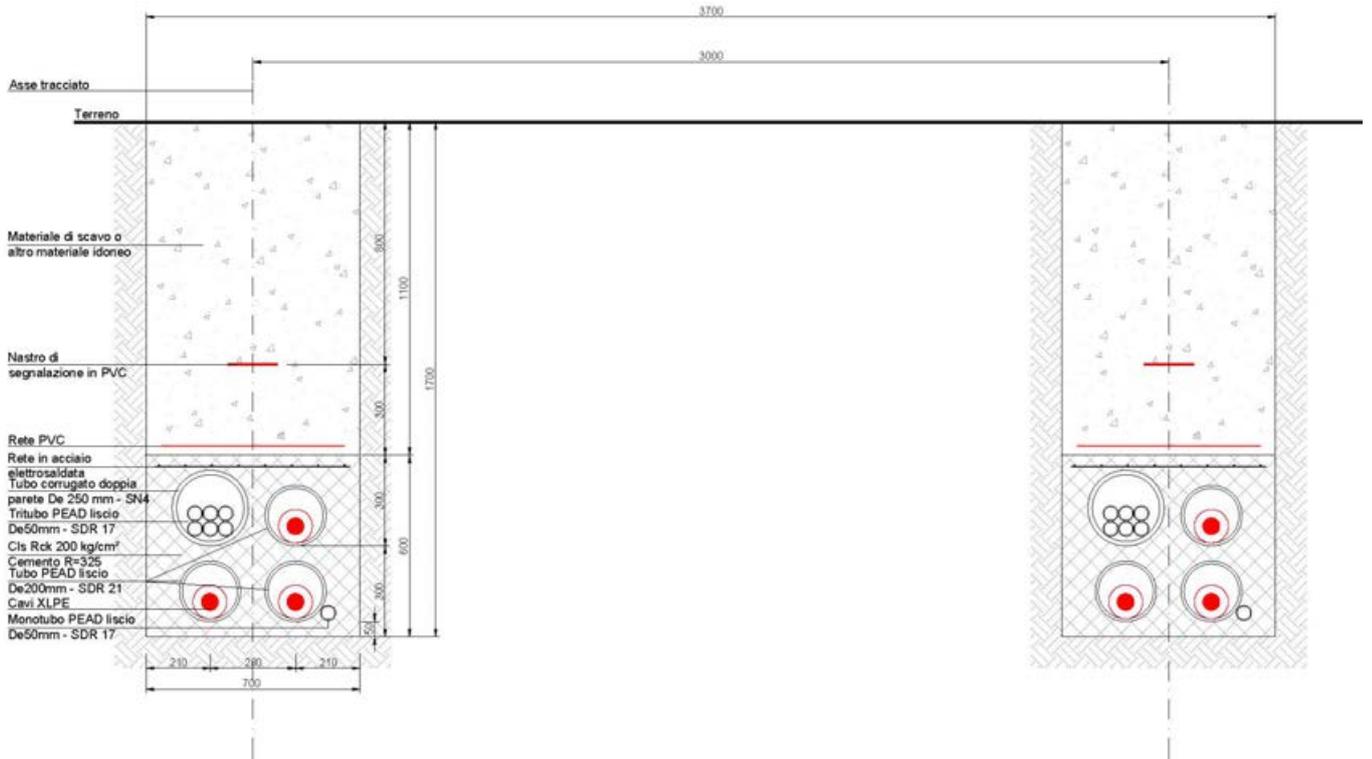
Sezione tipo di posa doppia terna C1
